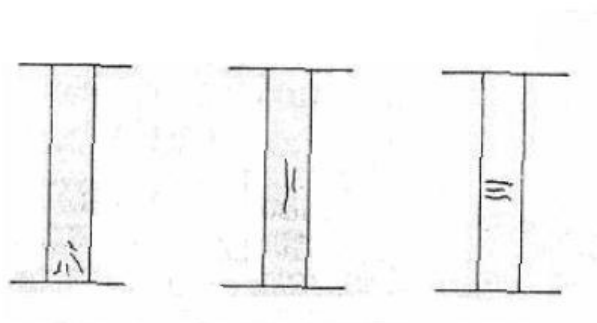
Fissuras típicas em pilares de betão armado (Esmagamento; Insuficiência de estribos e flexão com compressão, respectivamente) [1]
